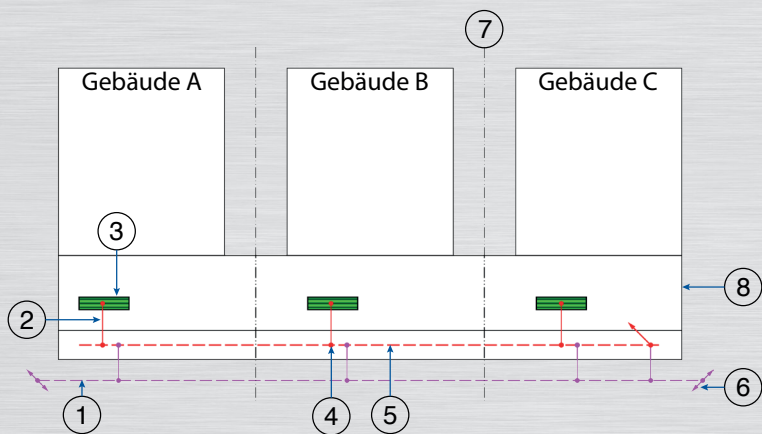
Anordnung eines Ringerders bei einem Gebäude mit mehreren Netzanschlüssen und einer gemeinsamen Erdungsanlage
